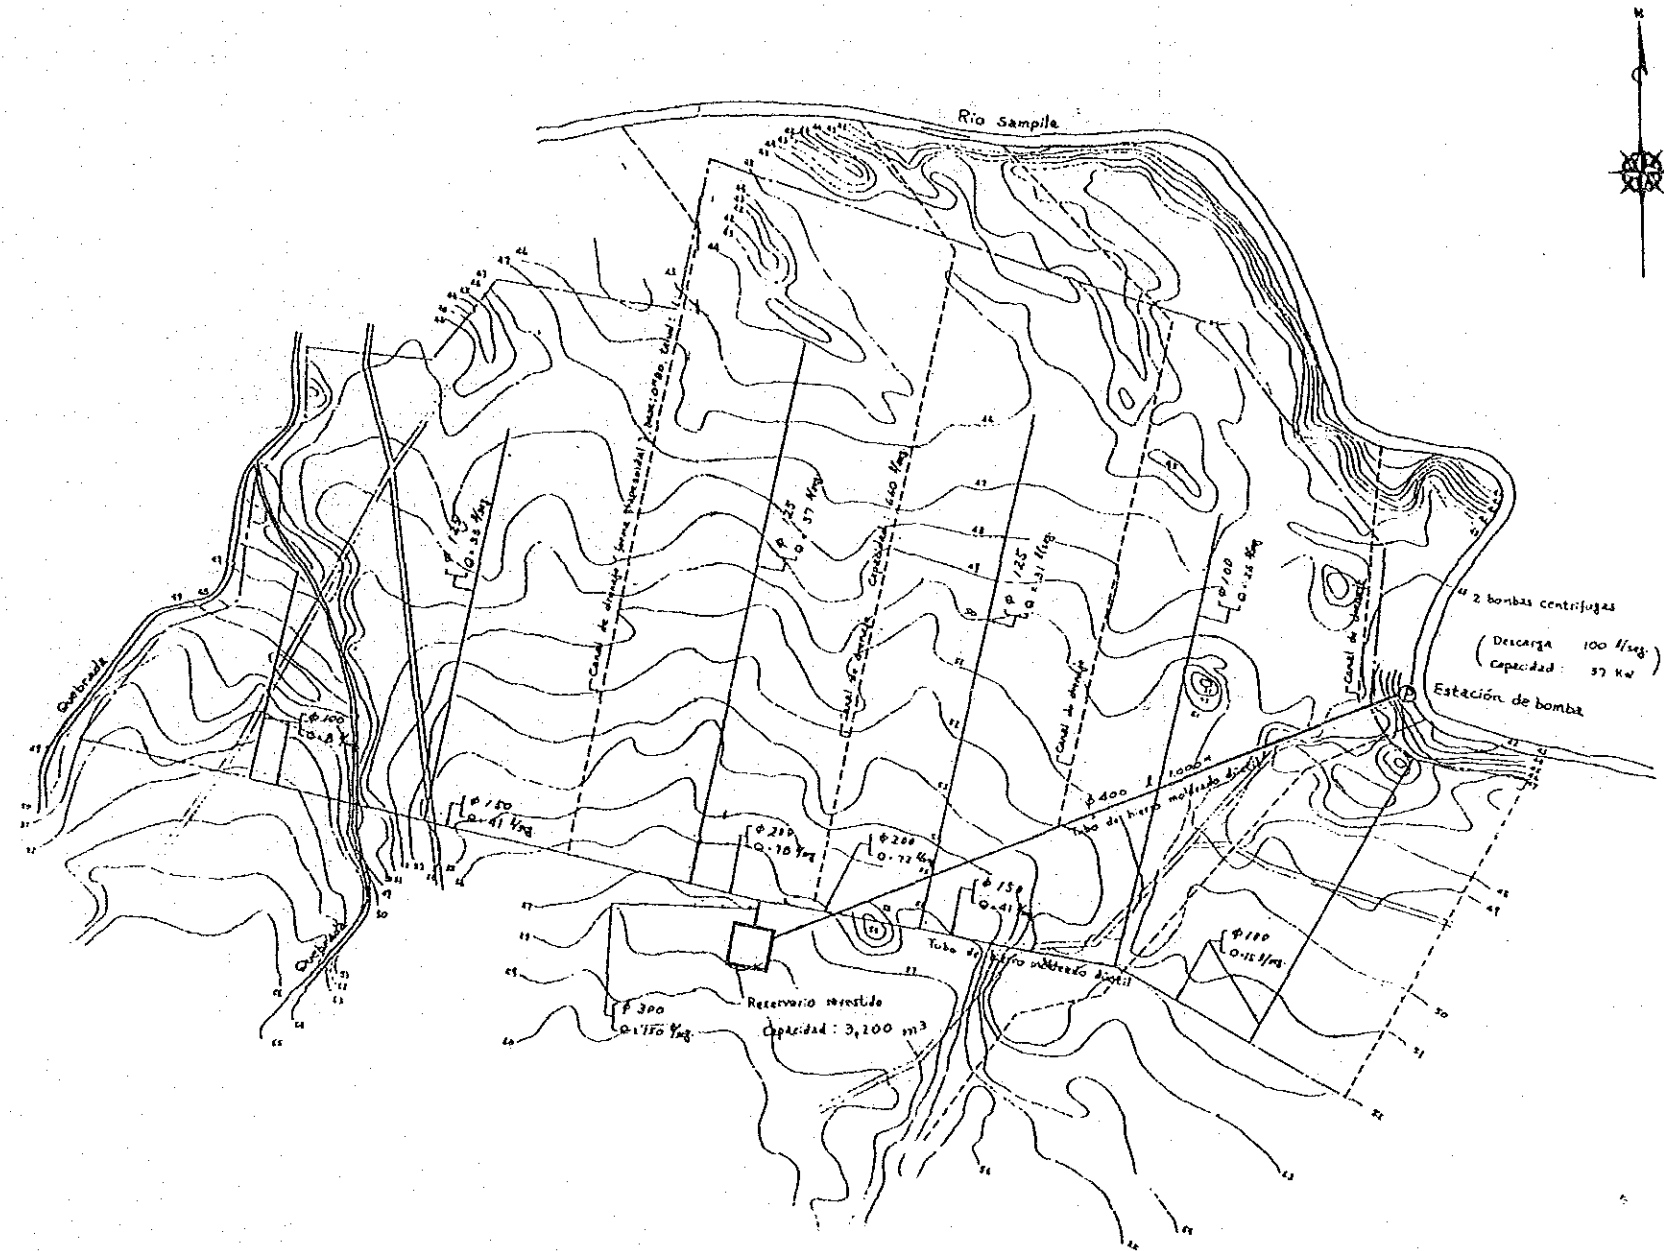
Planta de Riego y Drenaje(El Transito)
